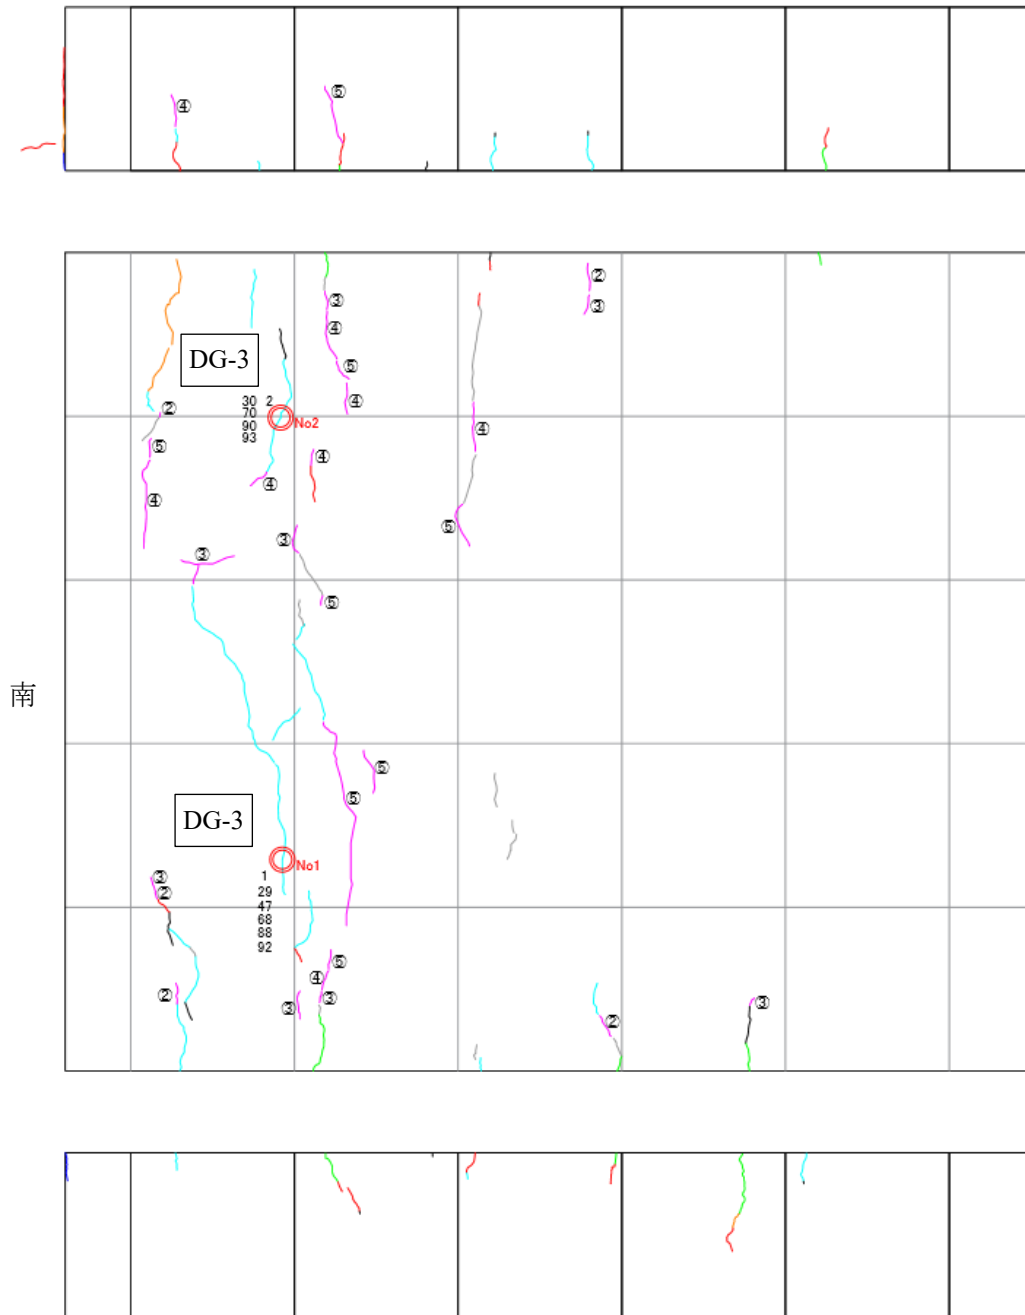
ひび割れ状況 (端部上面：南側)
